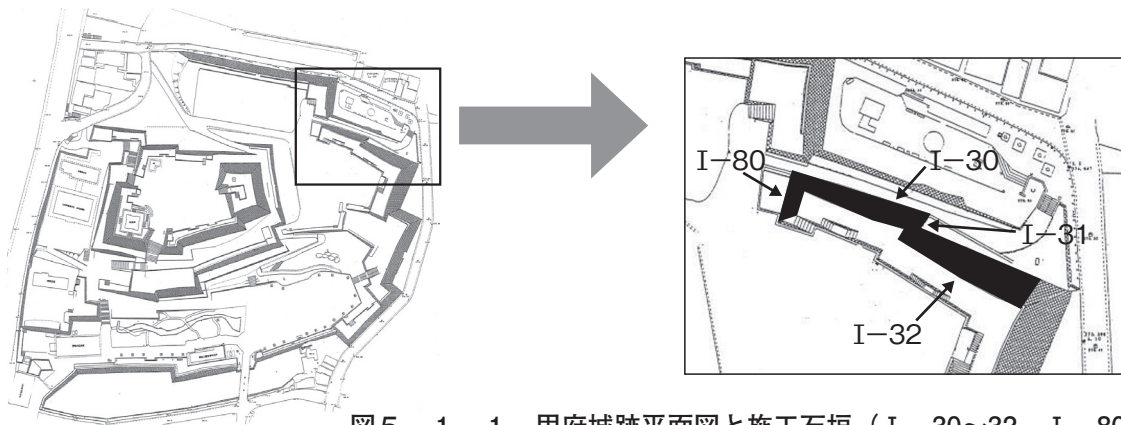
甲府城跡平面図と施工石垣（I-30～32、I-80）
